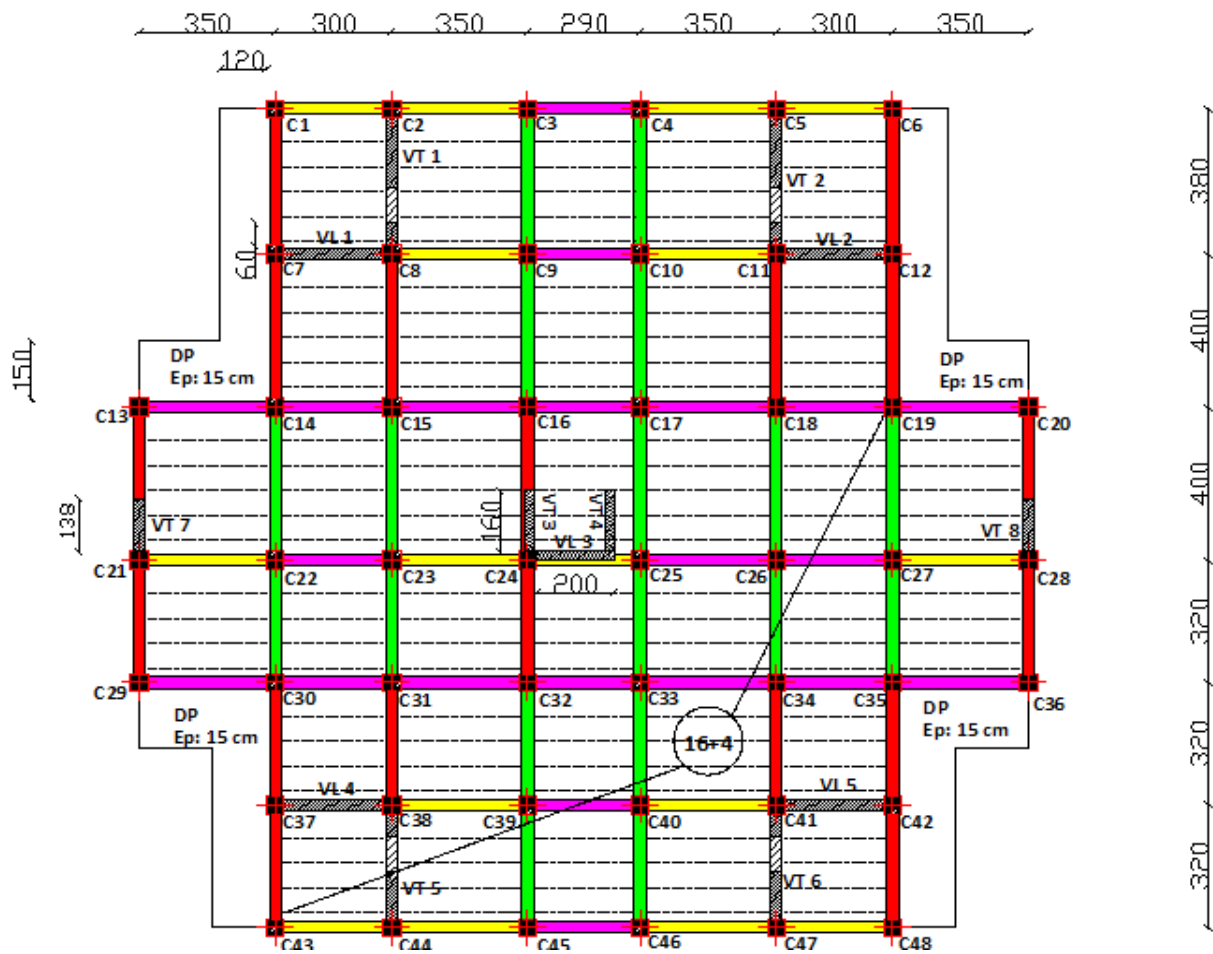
Groupe des poutres pour le ferrailage de la cinquième variante
